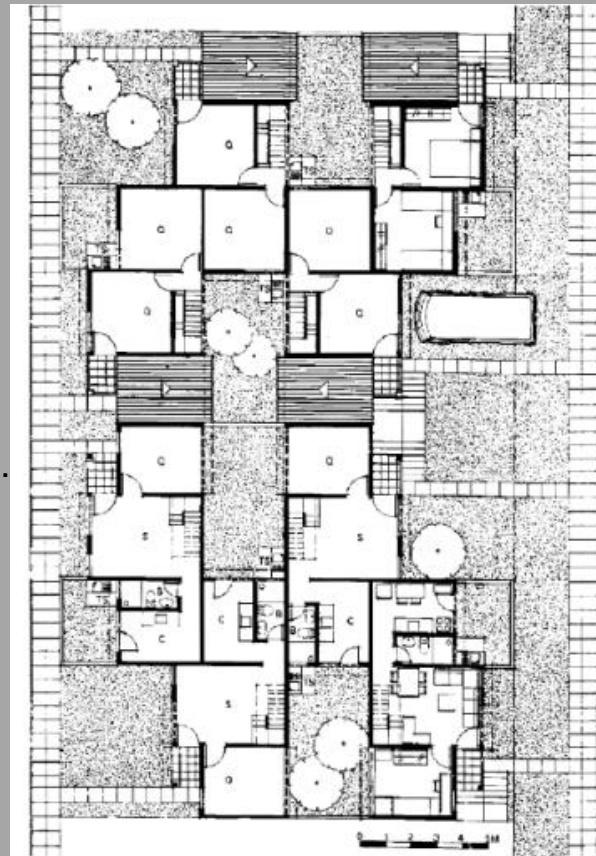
Plantas de unidades acopladas - Metade inferior - pavimento inferior; metade superior - pavimento superior.
